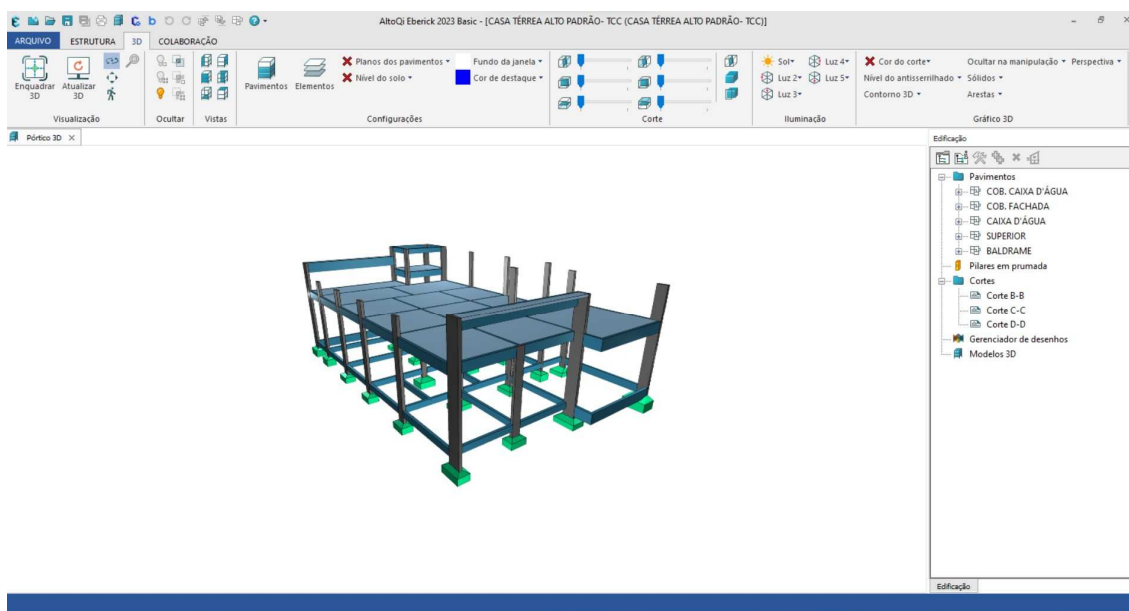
Concepção e lançamento dos elementos estruturais de projeto.
